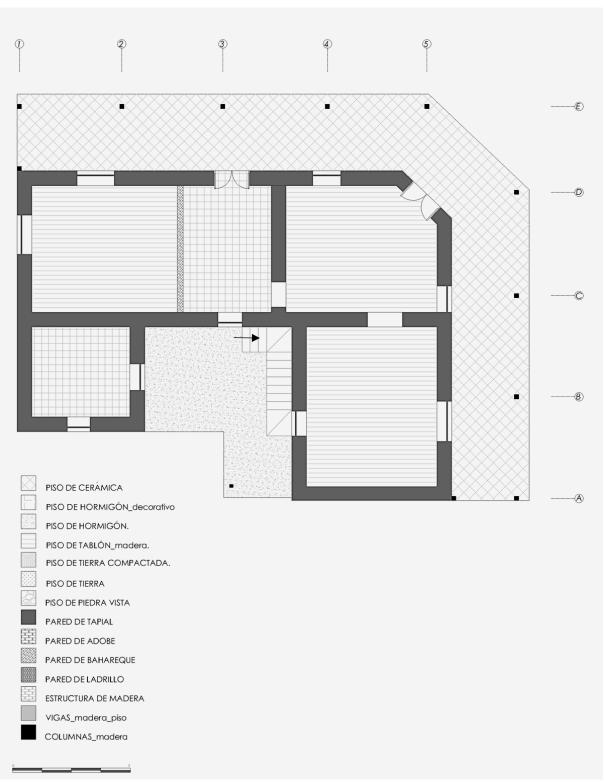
Planta arquitectónica (2°), de un poblador extranjero
